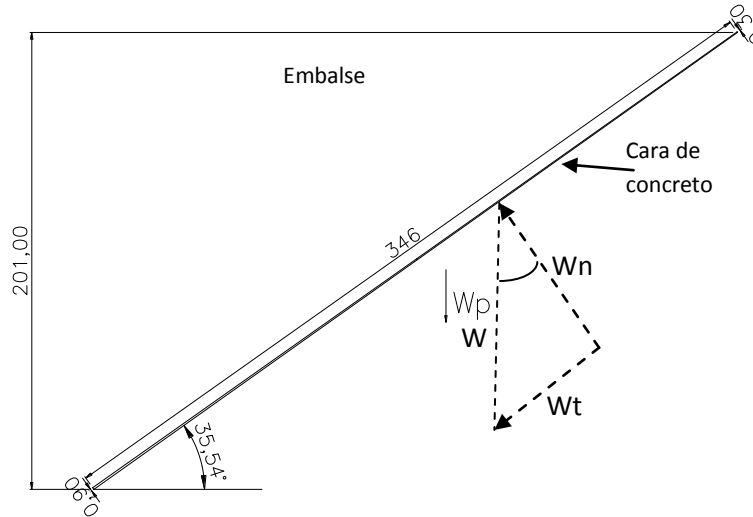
Sección transversal de la cara de concreto en el tramo 6-7 del plinto.
